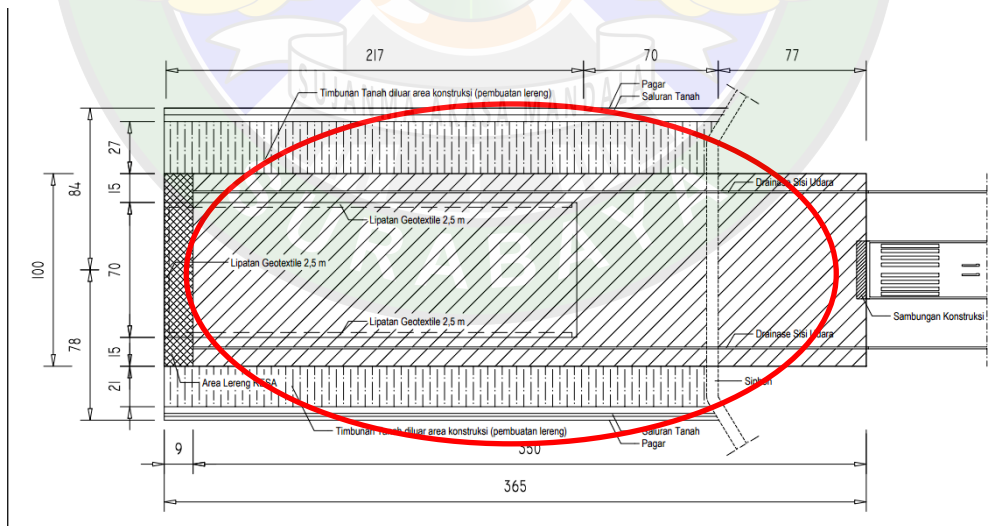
Survey Lapangan Perpanjangan Runway
